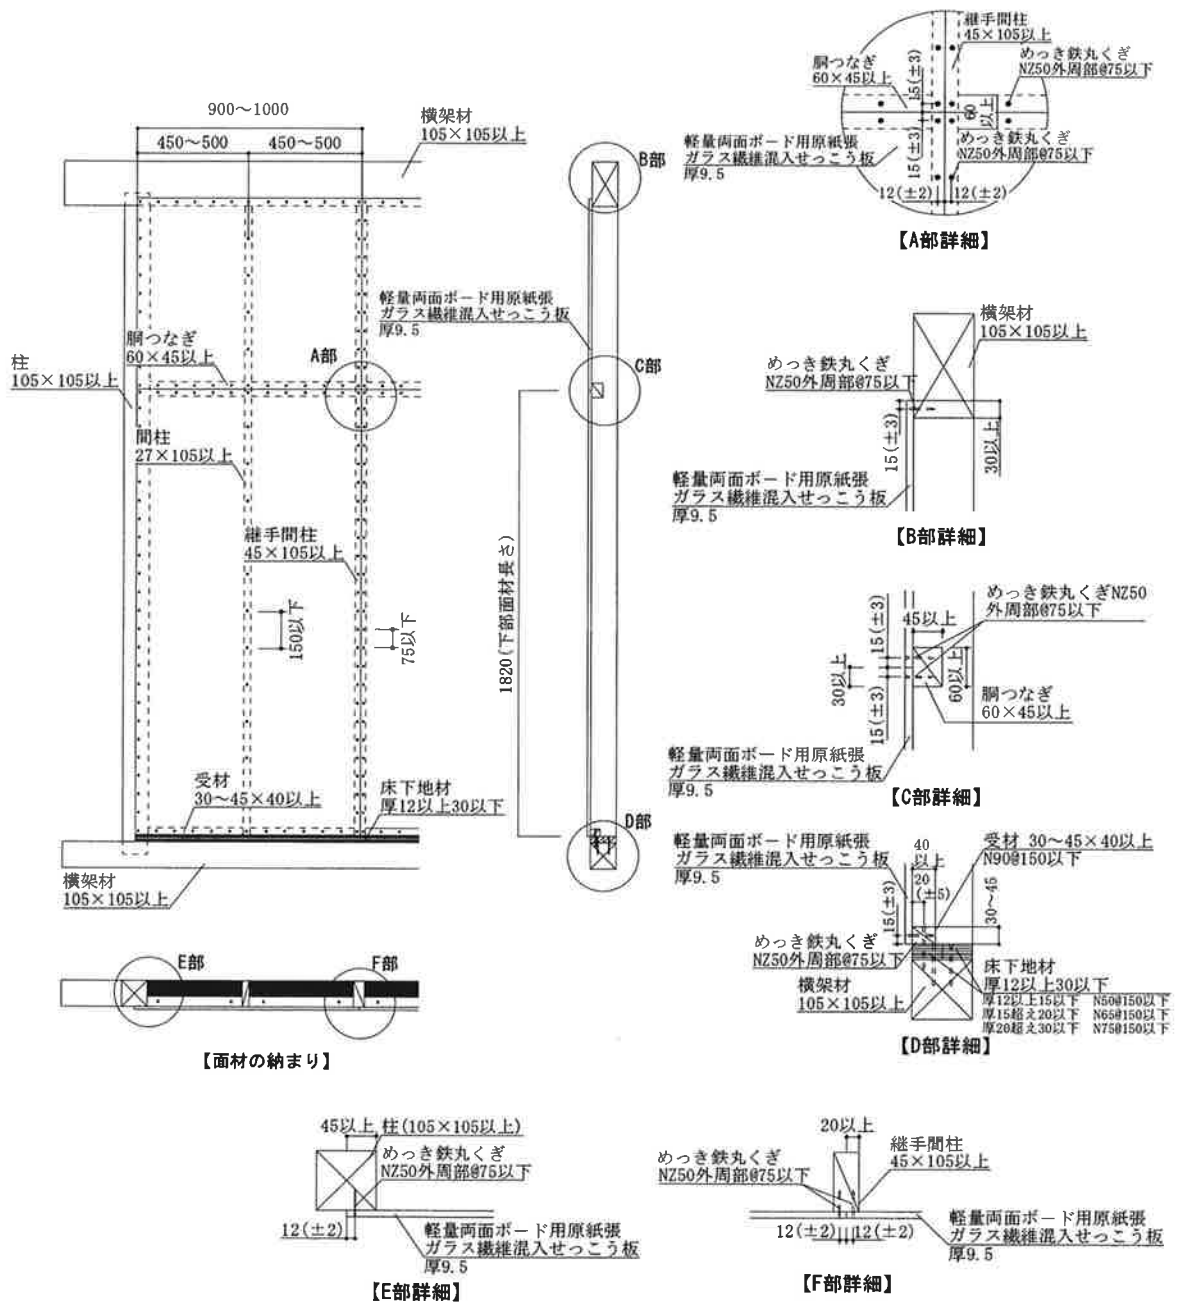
施工図：縦継ぎ張りの場合 (寸法単位：mm)
